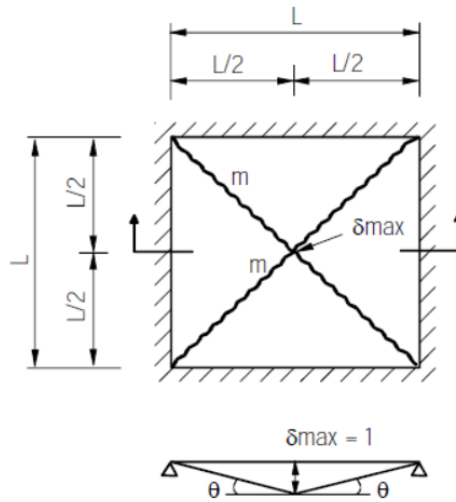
Laje simplesmente apoiada armada nas duas direções já com o padrão de linhas de roturas definido [41].
